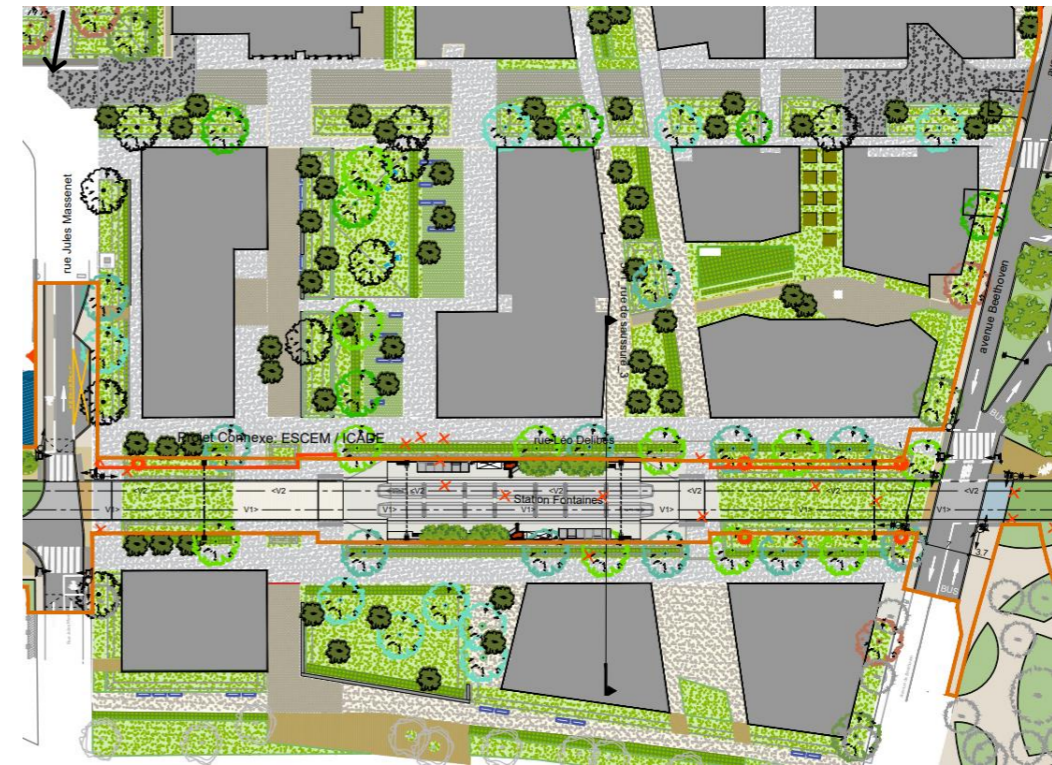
PLAN D'AMENAGEMENT PROJET RIVE SUD ET STATION FONTAINES
